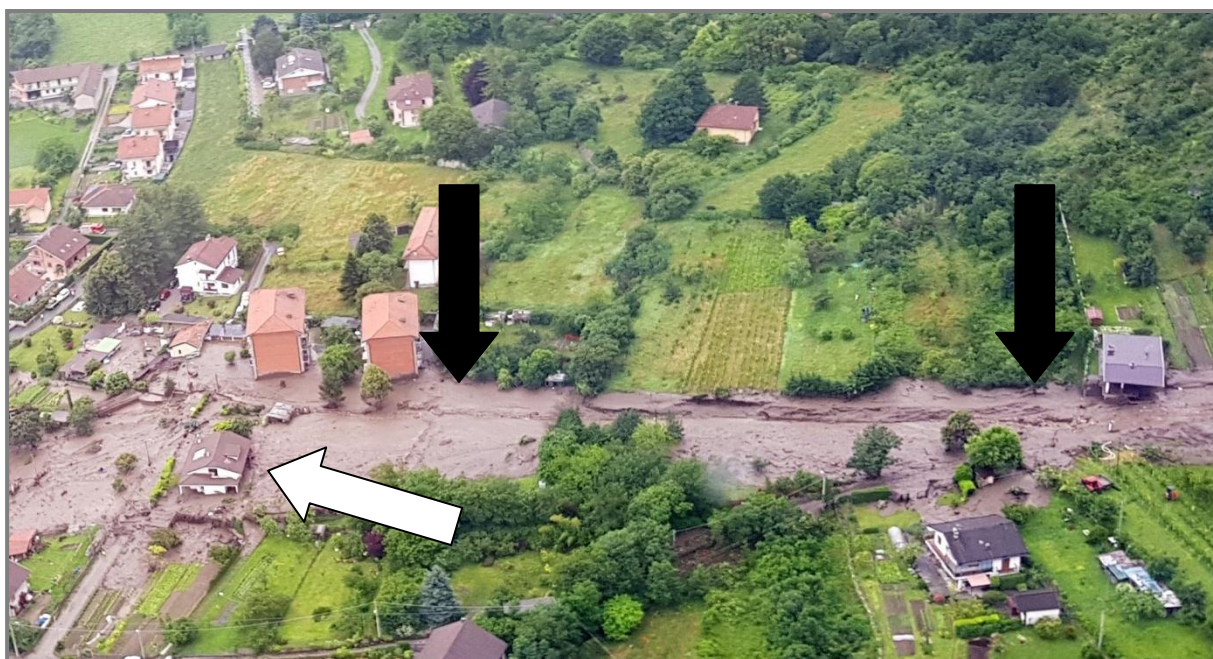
sorvolo con elicottero dell'area dall'evento del 07 giugno 2018; in evidenza la costruzione gravemente danneggiata (freccia bianca) e le due costruzioni completamente distrutte (frecce nere) - (foto Santo La Ferlita studio Rosso – TO)
